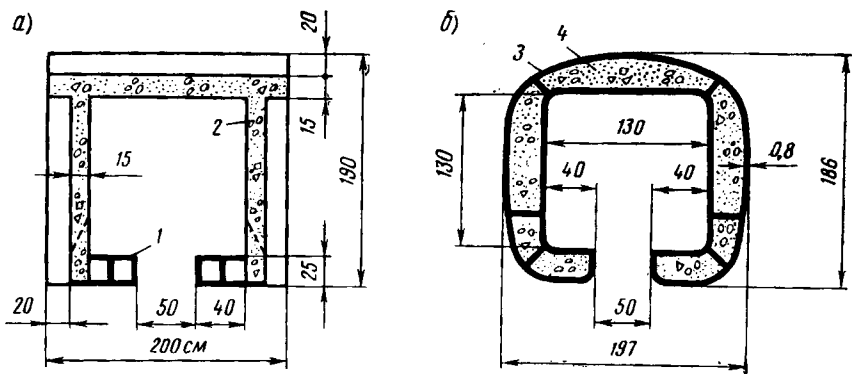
Поперечные сечения сталежелезобетонных монорейсов:
